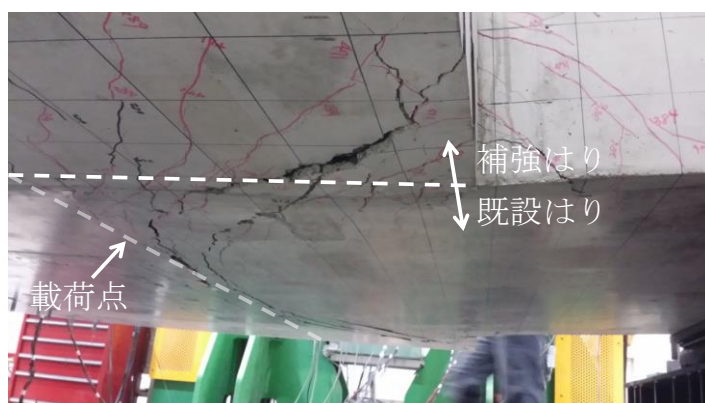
はり下面ひび割れ性状 (No.14)
